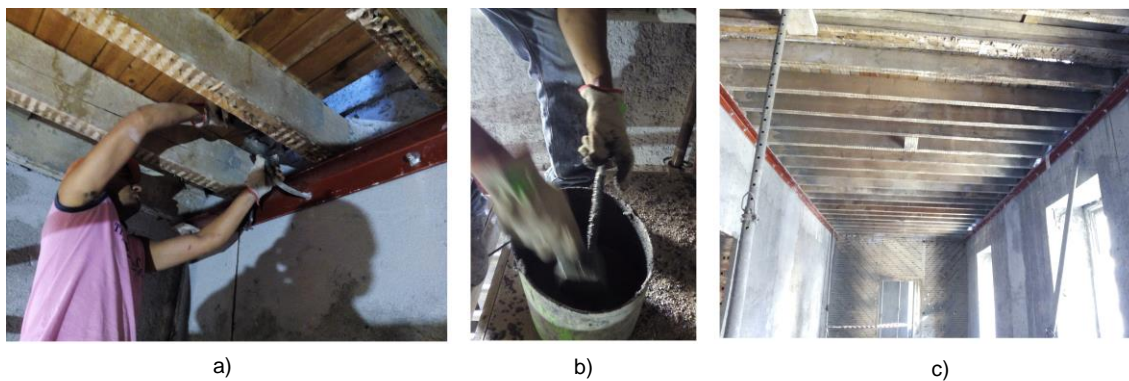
Ligação parede de alvenaria pavimento de madeira (A2P).
